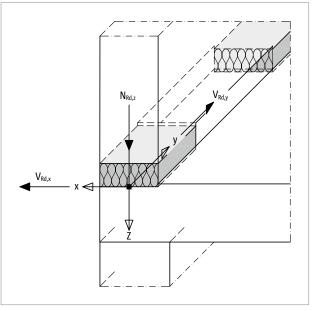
Schöck Sconnex® type W : convention des signes pour le dimensionnement
